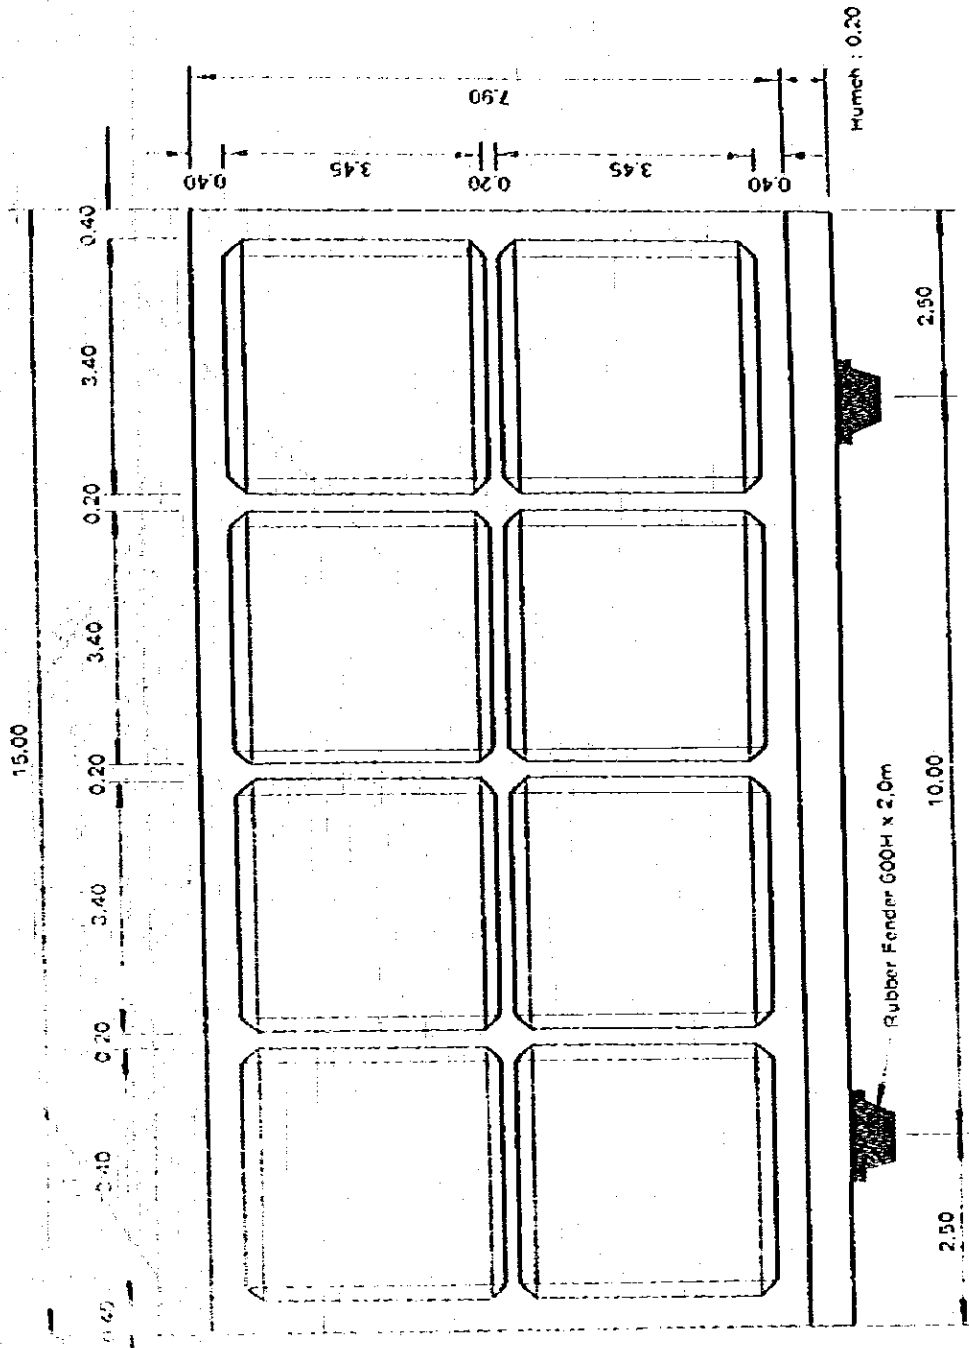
(a) 重力式ケーソンの標準断面図 (一10m)
